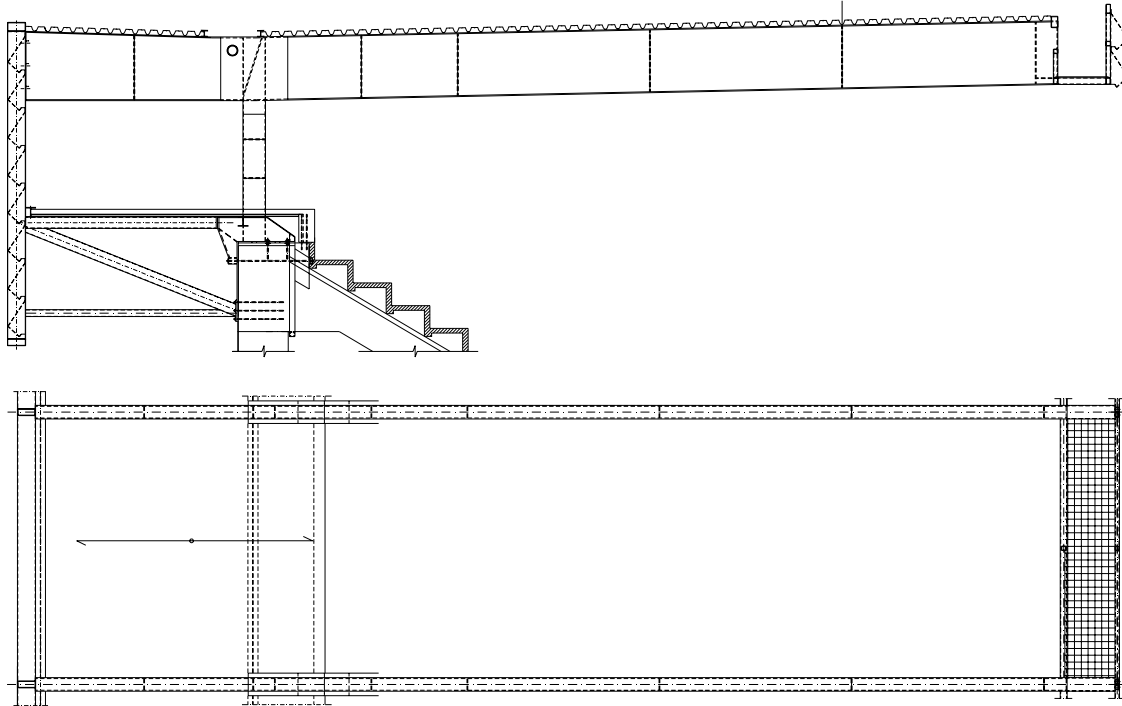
Nueva cubierta y cruja. a) Alzado. b) Planta
